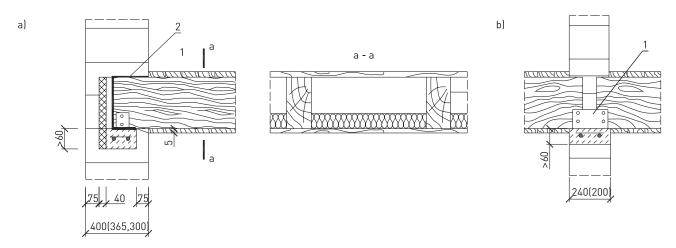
Опирание деревянных балок перекрытия на венец, выполненный из U-образных блоков:
